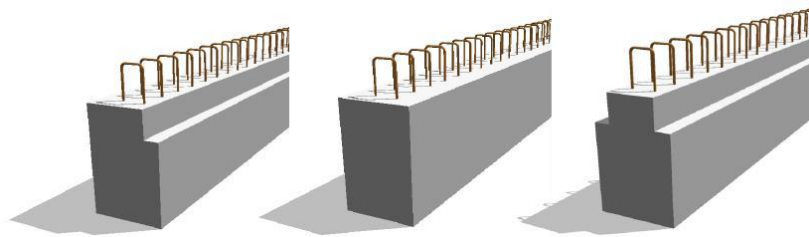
Vigas prefabricadas de sección JL, JT y rectangular
